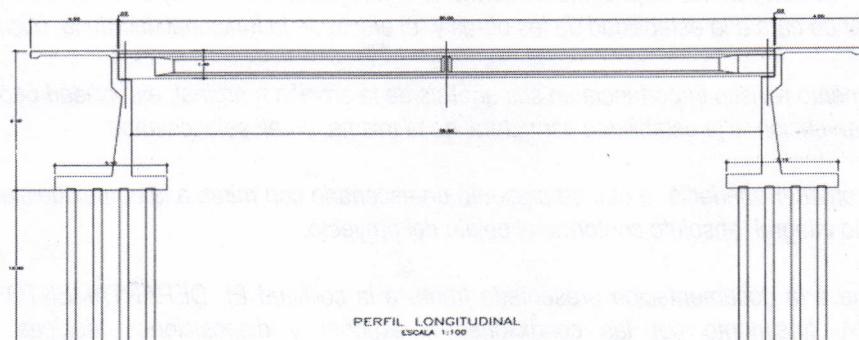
Imagen Planos Perfil longitudinal Estructural del Puente sobre la Quebrada Moreno
